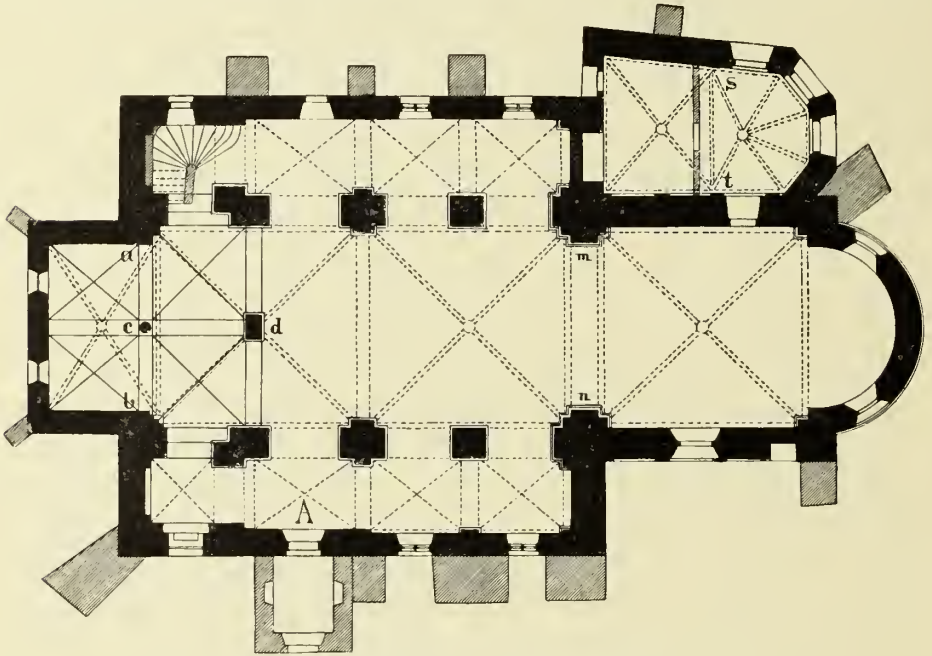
Stoppenberg Grundriss der Stiftskirche.
